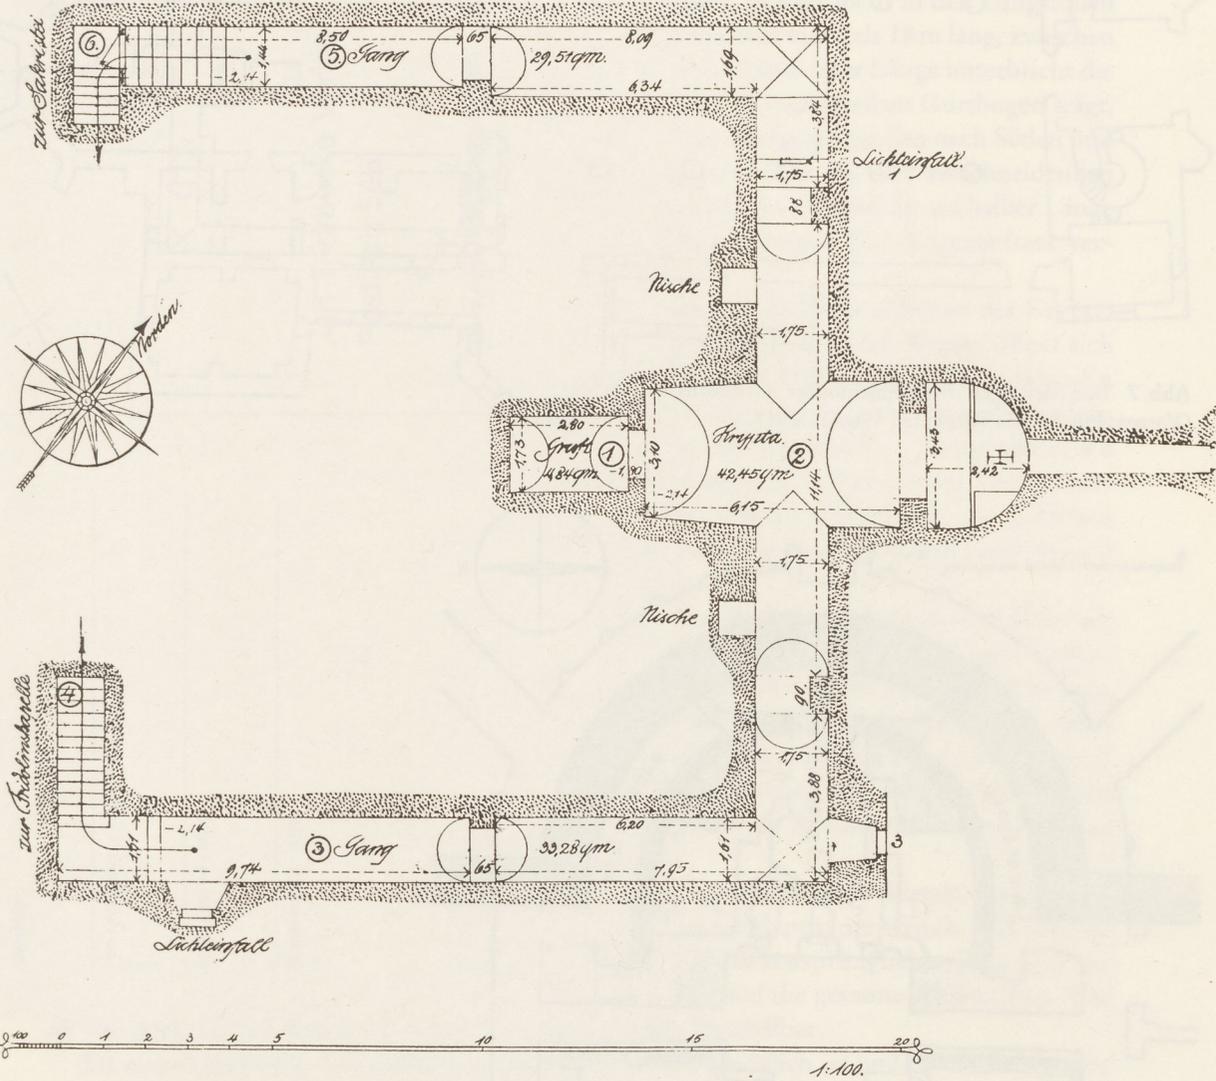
Bad Säckingen, Fridolinmünster, Grundriß der Krypta (Staatl. Hochbauamt Waldshut, 1914/18)
